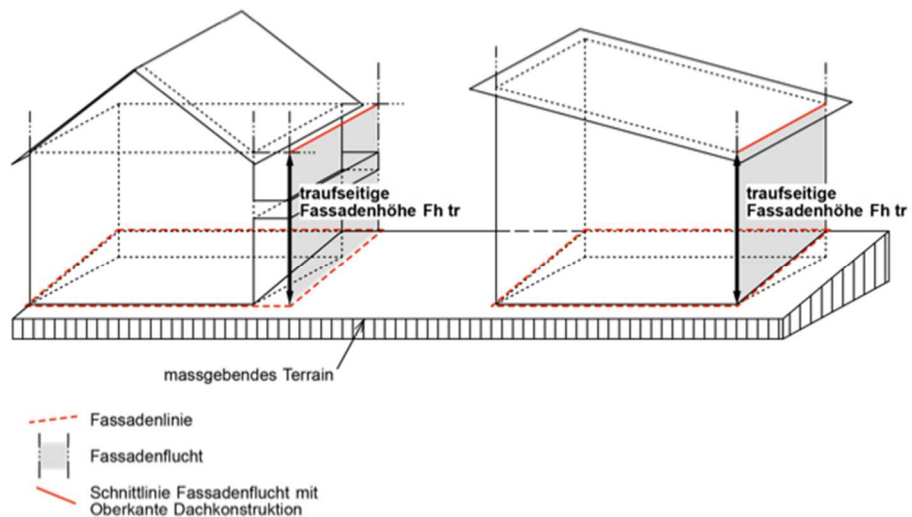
Skizze Art. 37 Abs. 4 Bst. a) BauR
